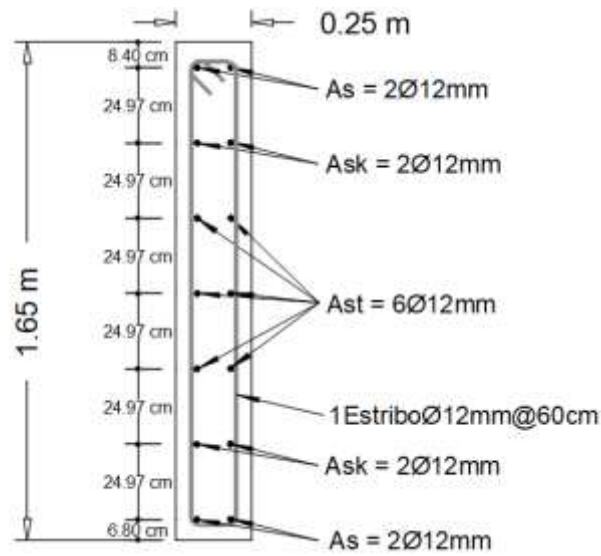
Corte transversal del diagrama para puentes losa sobre vigas.
